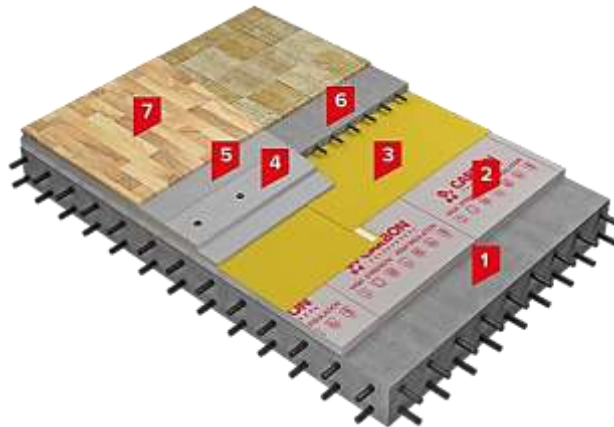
Конструктивне рішення цокольного перекриття над холодним підпіллям: 1 – залізобетонна плита перекриття; 2 – екструзійний пінополістирол; 3 – пароізоляційна плівка; 4 – збірна стяжка з гіпсоволокнистих плит; 5 – підкладка зі спіненого поліетилену; 6 – цементно-піщана стяжка; 8 – покриття підлоги
